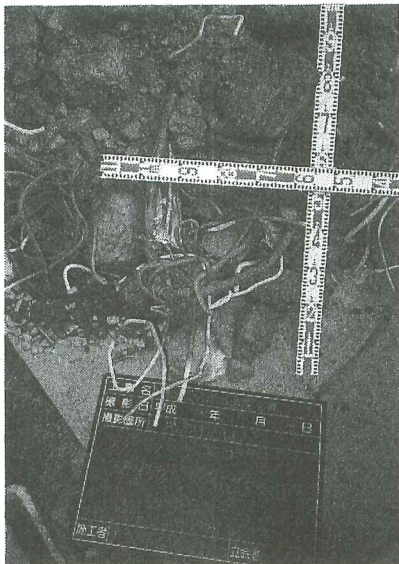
地中障害物の旧地下躯体の掘削後、取出された鉄筋およびパイプ類
